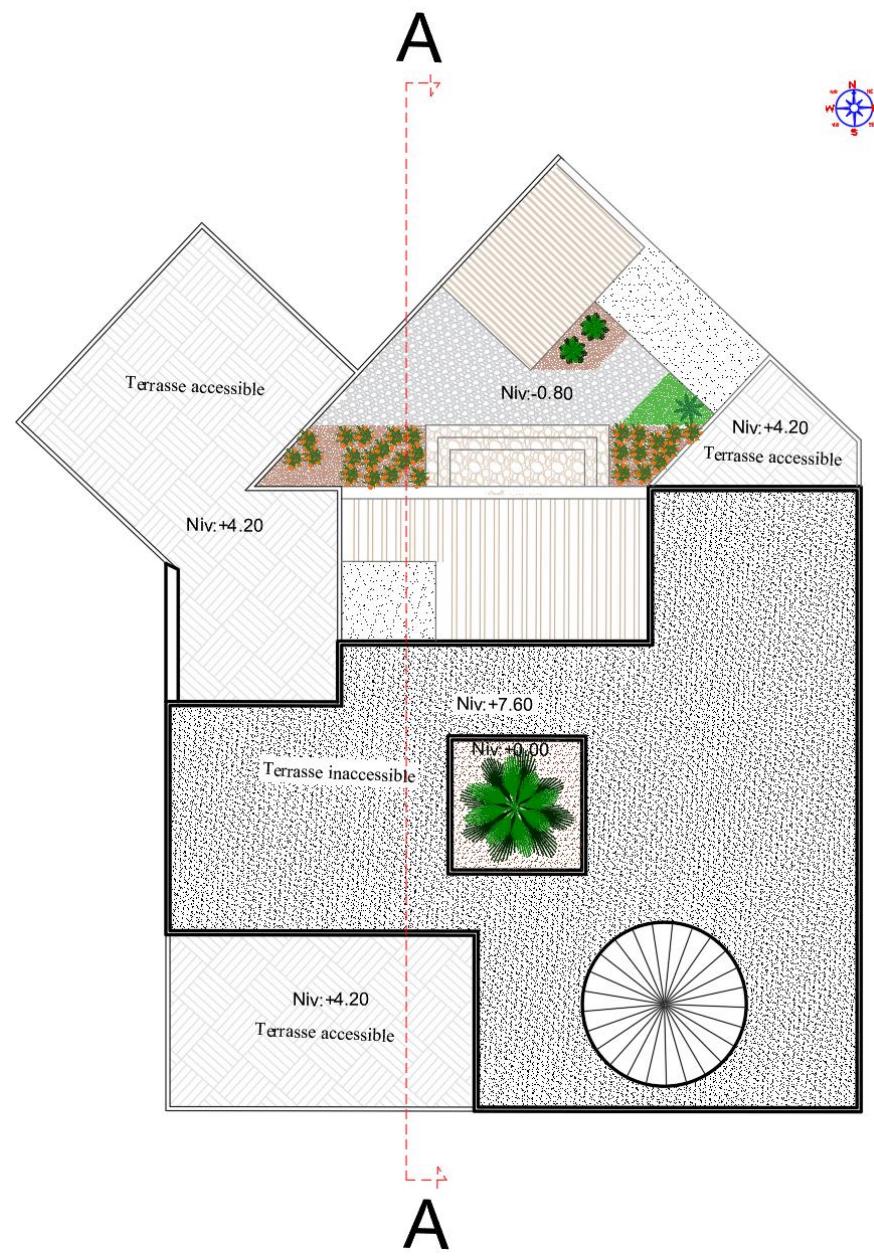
PLAN DE TOITURE DU LOGEMENT TYPE 3 ;
